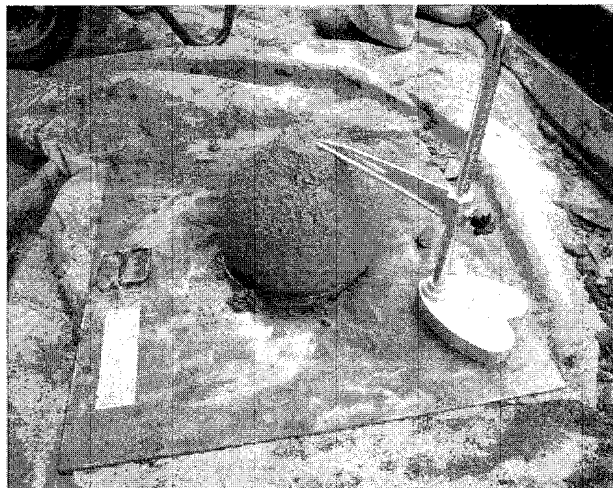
スランブ試験状況 (スランブ 14.5 cm)
